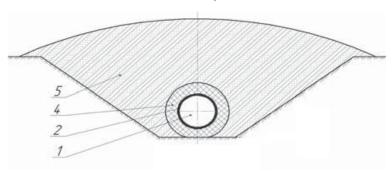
Поперечный разрез траншей с упругодеформируемыми элементами: 1 — трубопровод, 2 — скальный лист, 4 — упругодеформируемый элемент, 5 — грунт засыпки (гравий или щебень)
